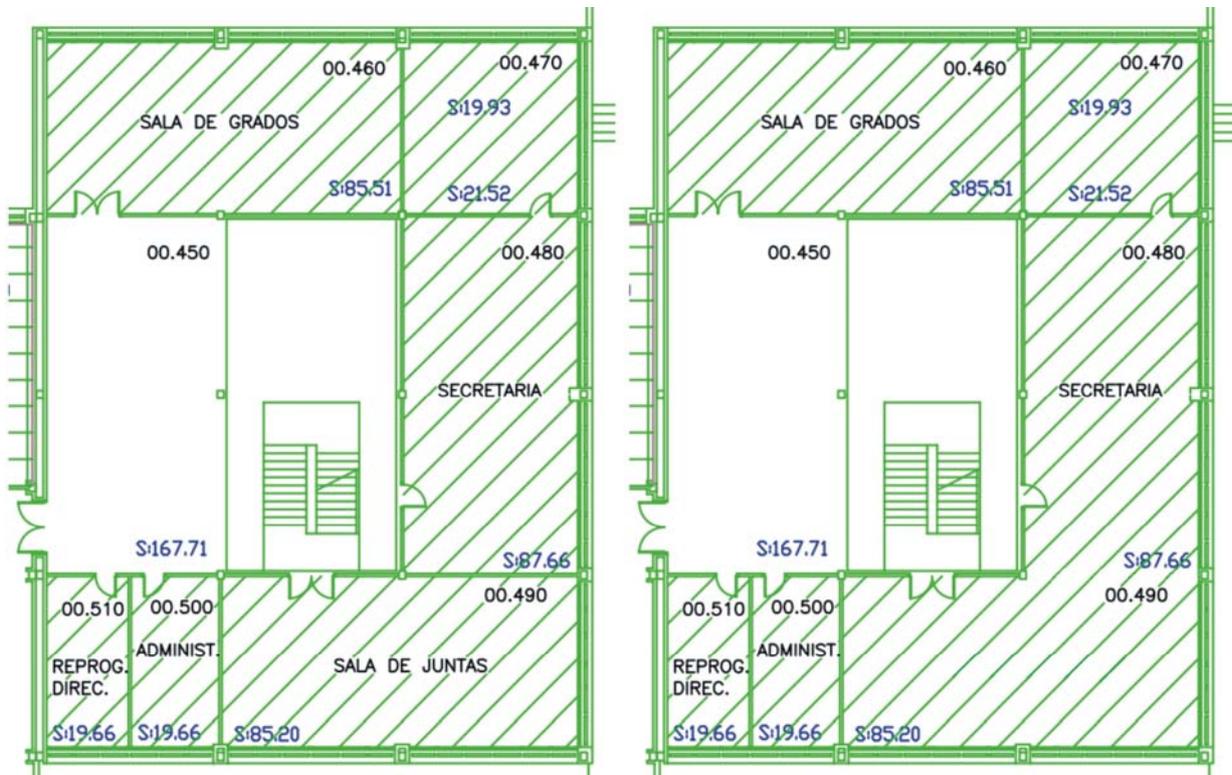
7. Plano de modificación de espacios en Ed. Torres Quevedo (planta baja)
